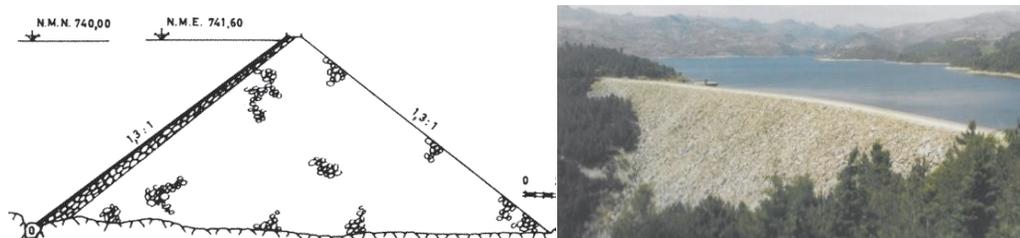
Perfil transversal e vista do paramento de jusante da barragem da Paradela.
